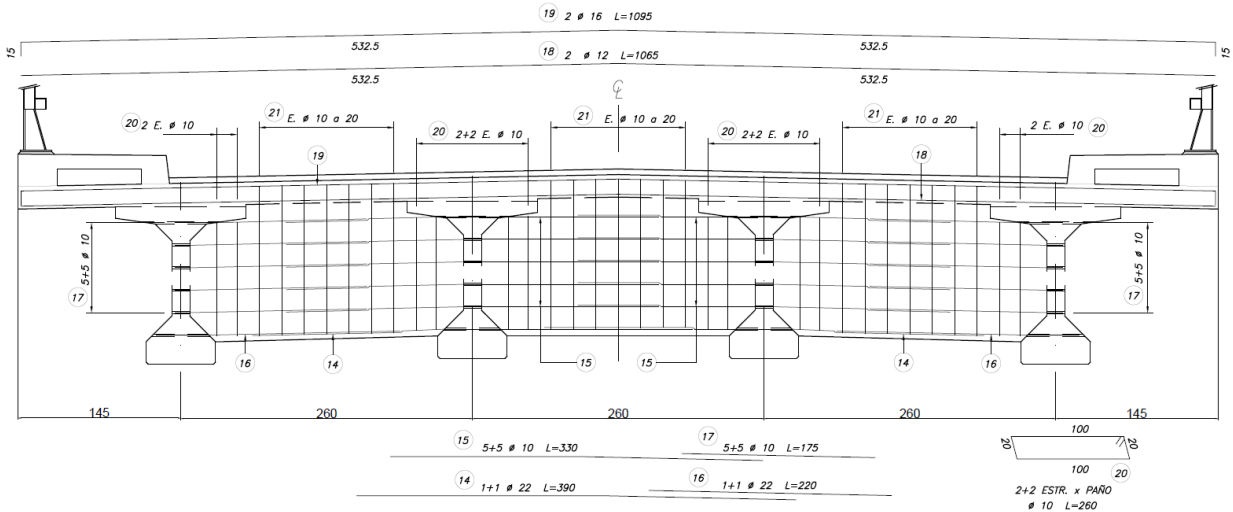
Detalle de Travesaño Puente Águila Norte.
